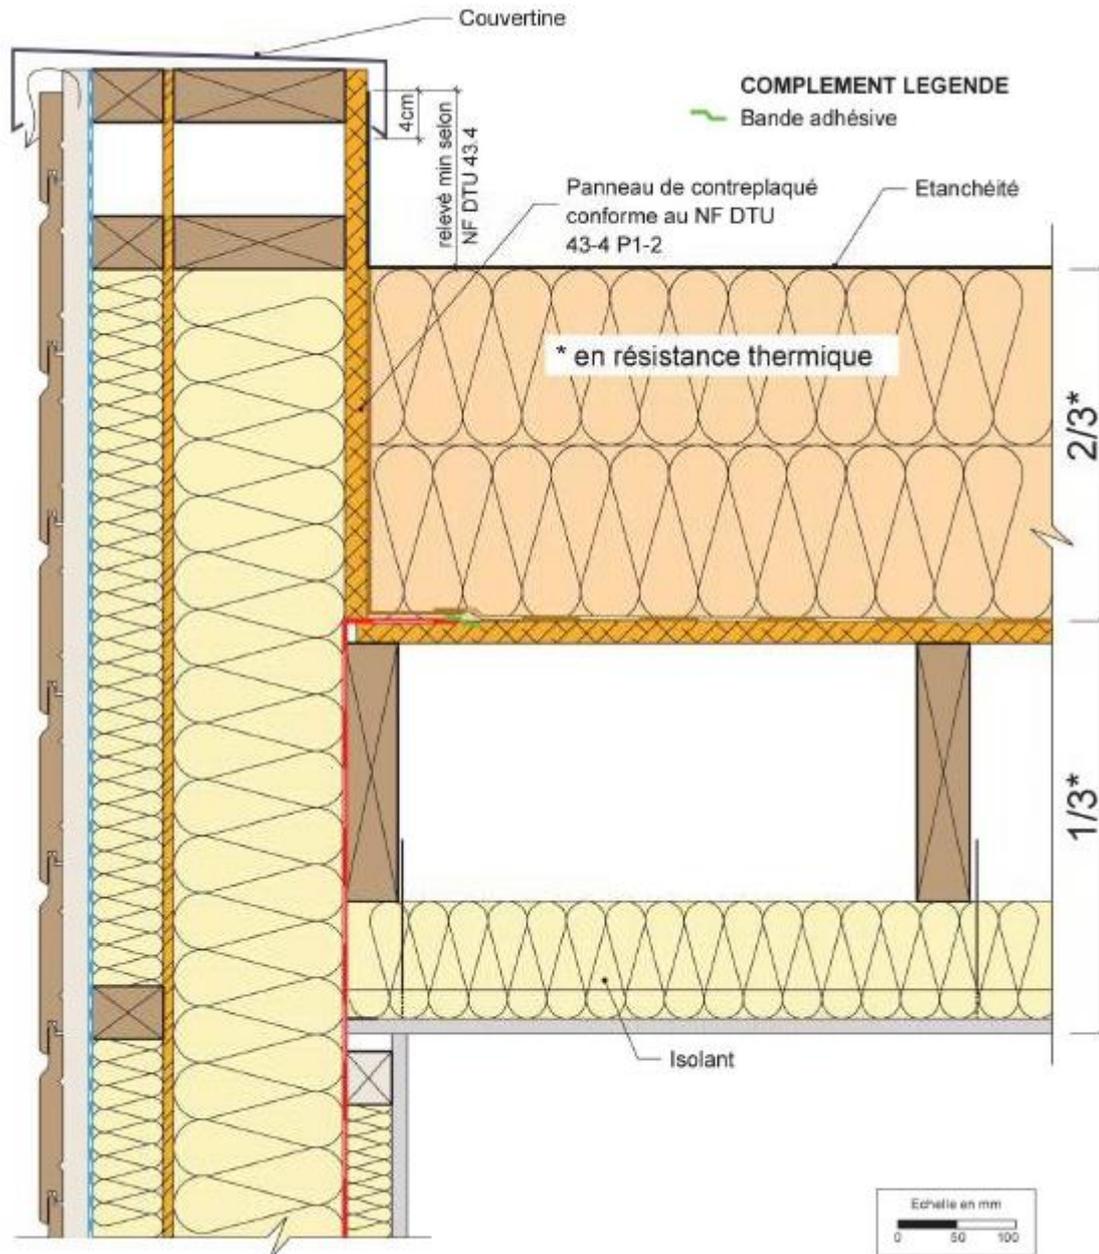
Exemple de raccordement entre les pare-vapeurs du mur et de la toiture (coupe verticale)
